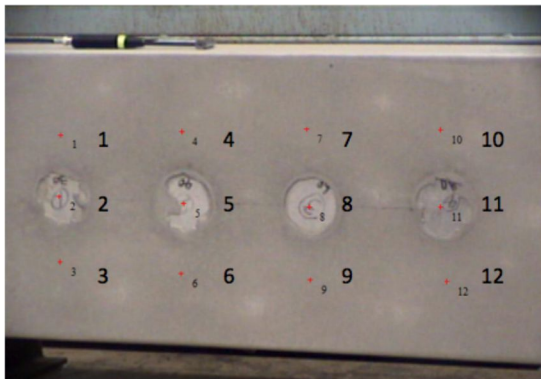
強度の異なる円筒状コンクリートが埋設されたコンクリート供試体と計測位置
